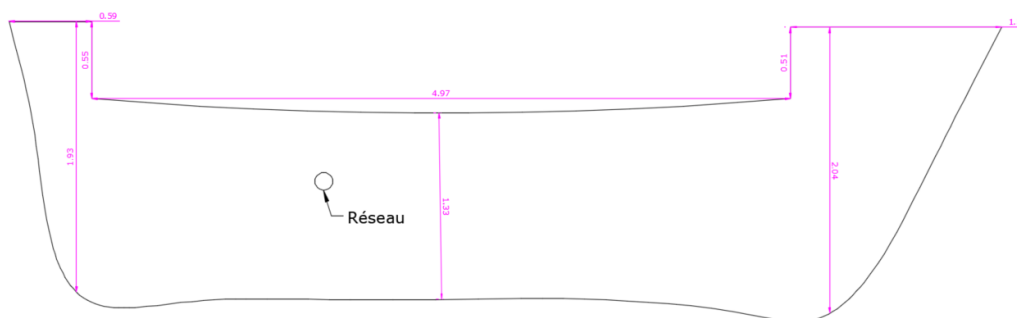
Schéma caractéristique - Élévation aval de l'ouvrage SE002
